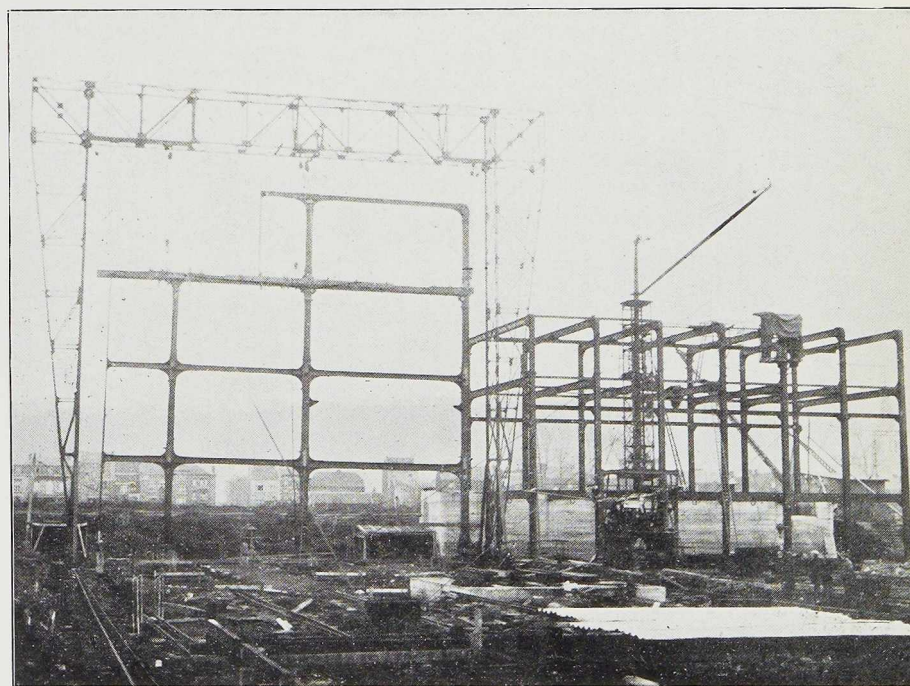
Mise en place d'un cadre métallique au moyen d'un portique spécial de levage.
